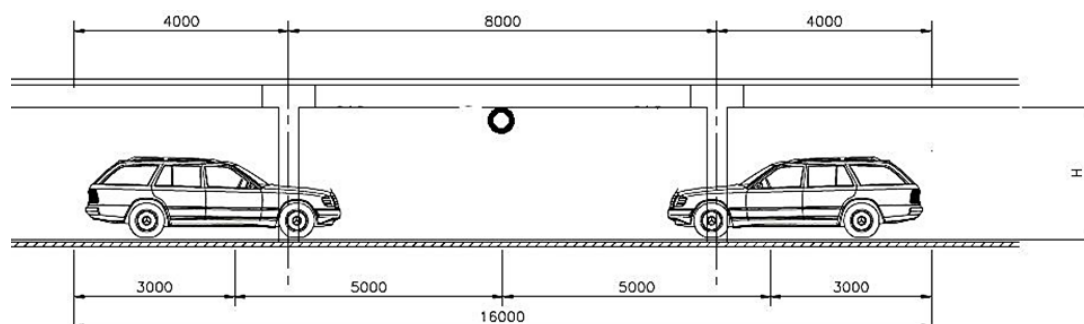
Расположение автомашин боком к вентиляционному воздушному потоку и струйных вентиляторов над центром дорожного полотна
